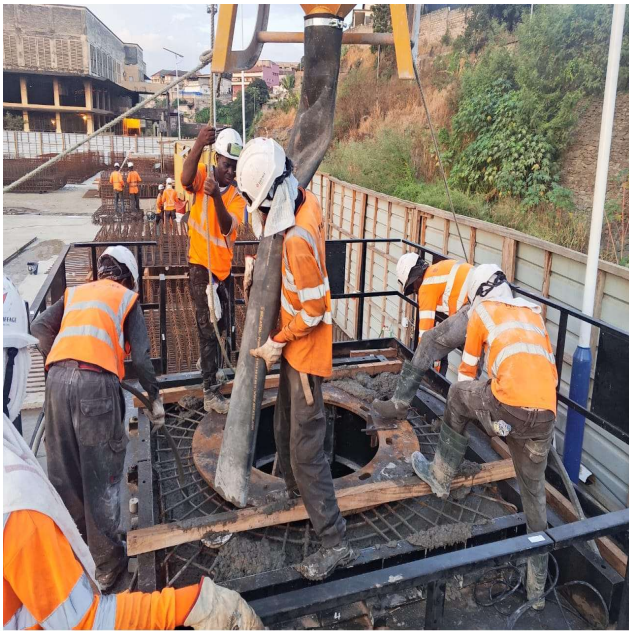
Bétonnage de chemise type 1 et prédalle Pd5-bs
